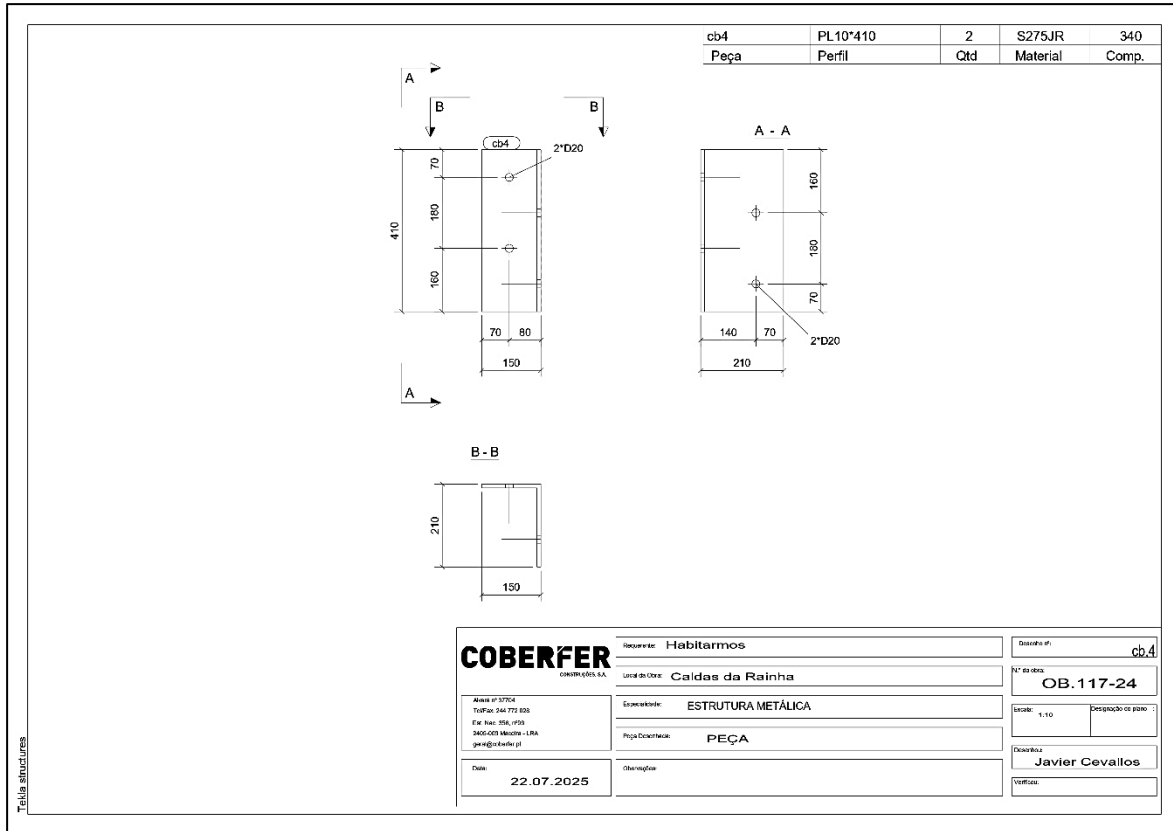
Desenho de corte da chapa “cb.4” (Autor/Coberfer)
